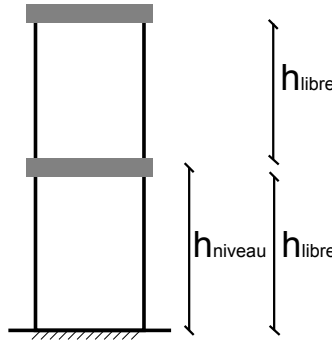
Différence entre hauteur libre et hauteur de niveau. La hauteur de niveau est la distance entre deux mi-épaisseurs de planchers successifs. La hauteur libre est la hauteur entre deux planchers.
